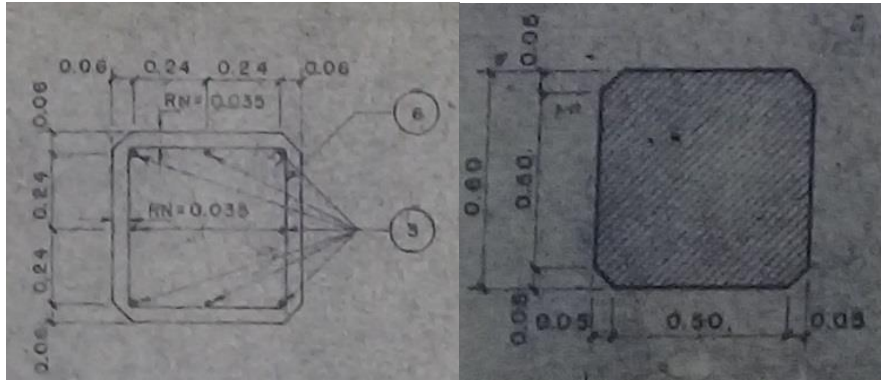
Columnas para pilas (ET-54-08)(Ivasenko 1975)
